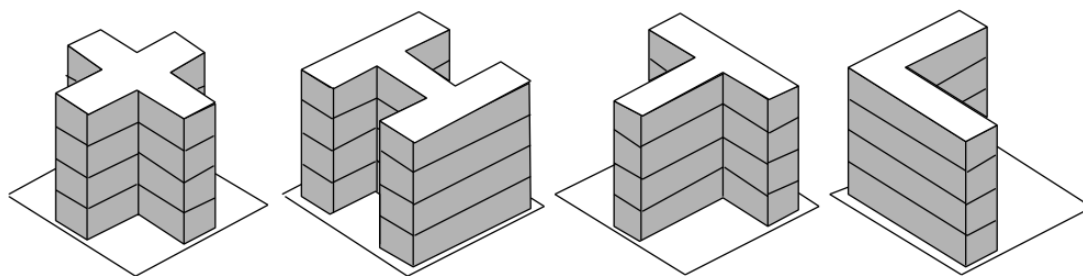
Plantas complejas (Organización Panamericana de la Salud, 2000).
